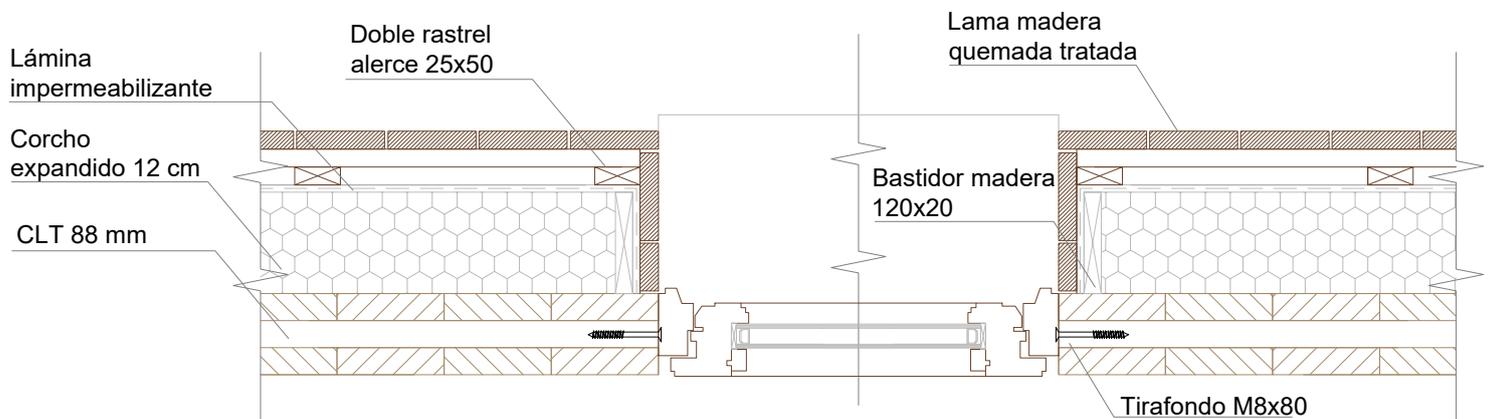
, 107 y 108: Detalles constructivos. Fuente: Elaboración propia
